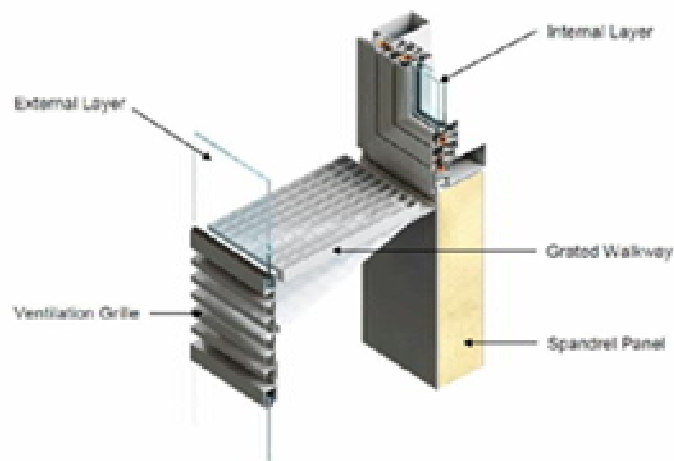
Plan et coupe typiques à mi-étage. (Faggal, 2014).
